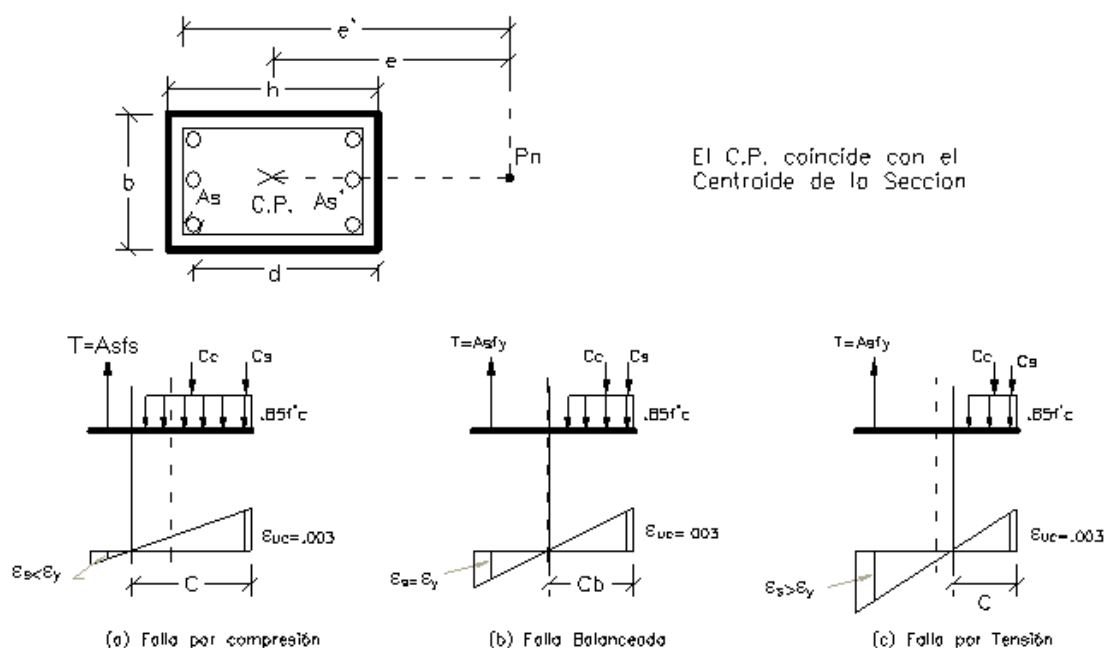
Tipos de fallas de columnas sometidas a flexo-compresión.
